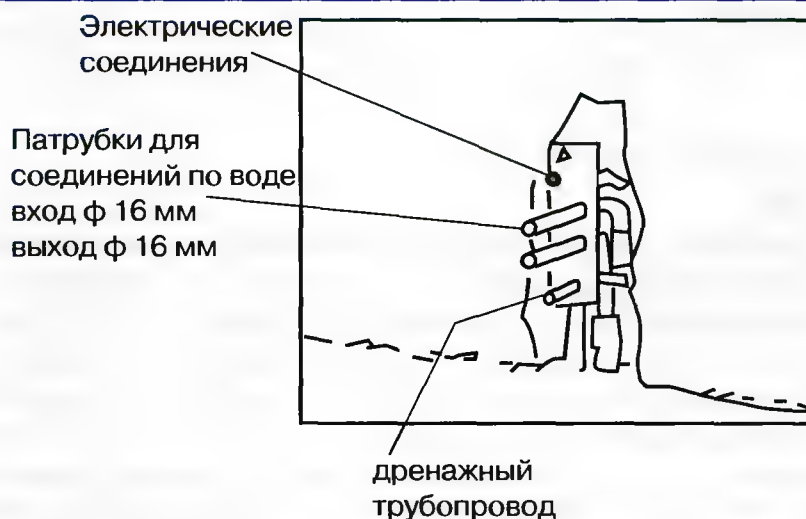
Монтажная плата для трубопроводов фэнкойла ELFO
